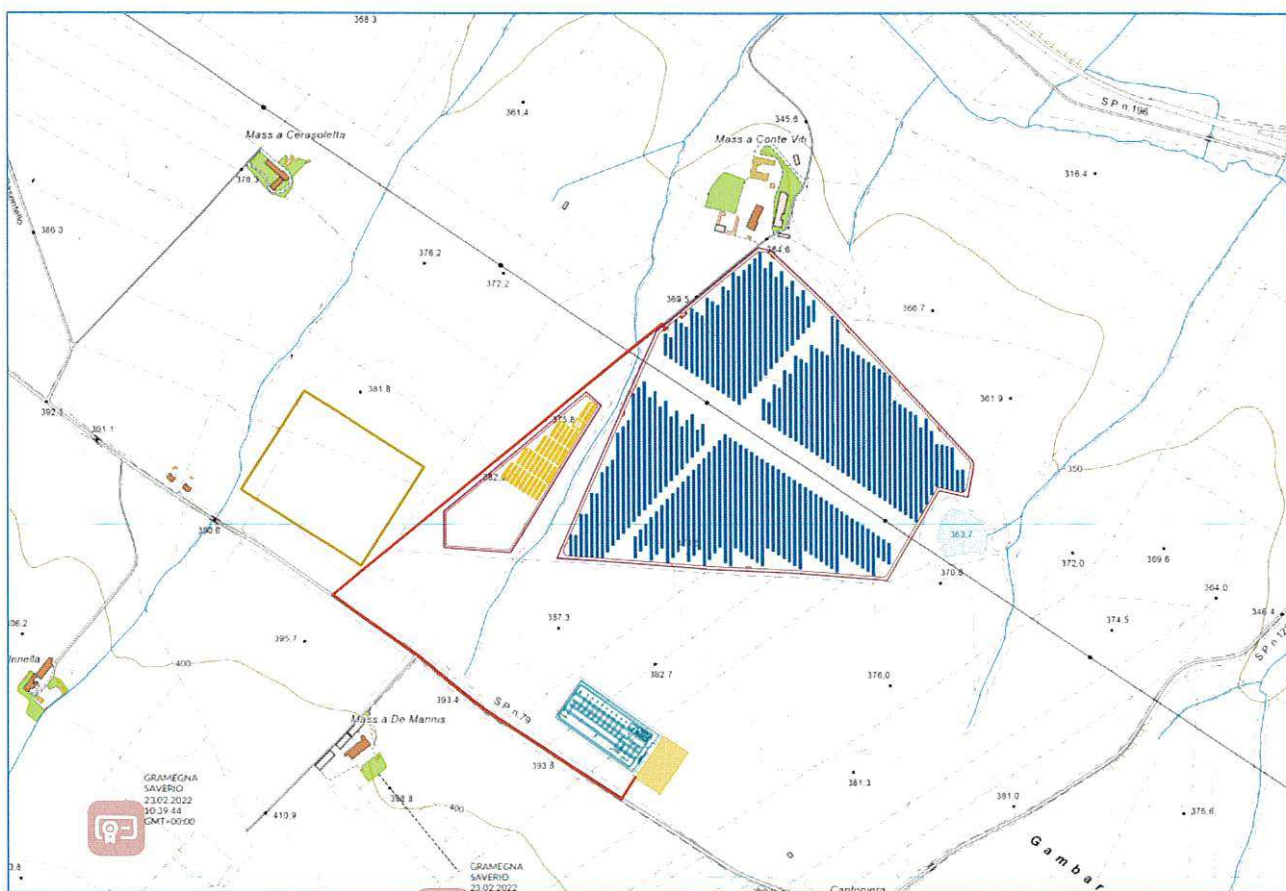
Elaborato A.12.a.6 "Planimetria dell'impianto"
